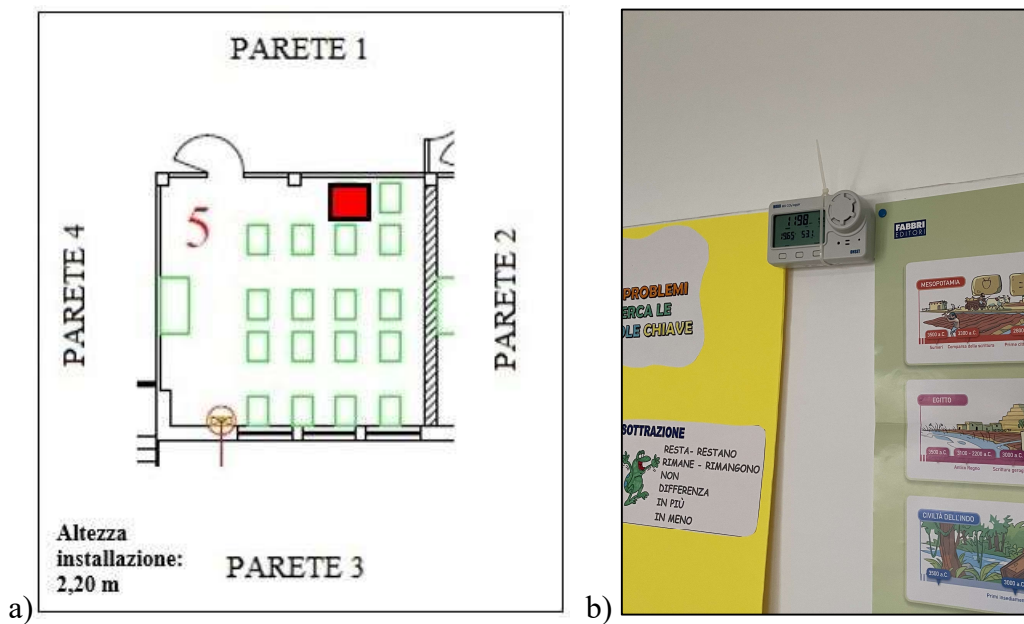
Posizione acquirente in pianta (a) e in foto (b) Aula 5 (4°B)
